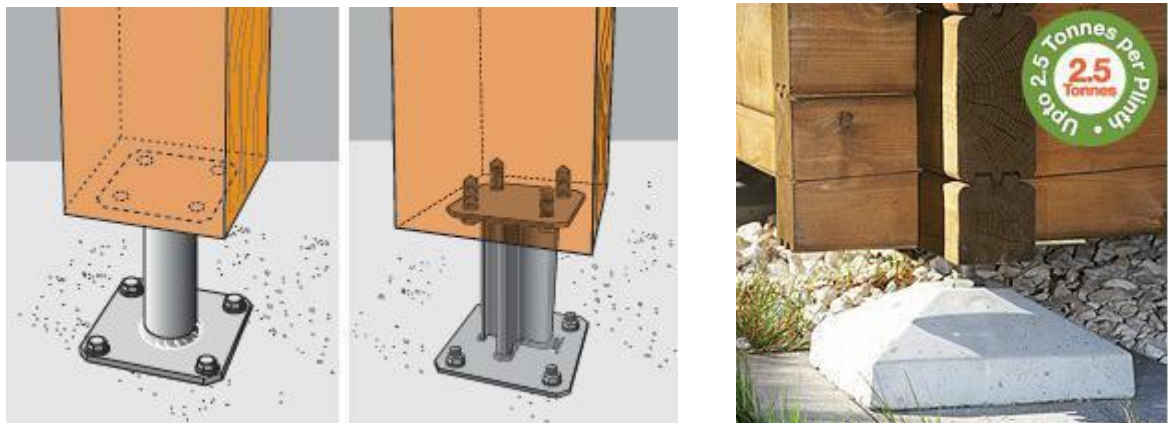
Exemplos de sistemas de sobrelevação [23] [62]
